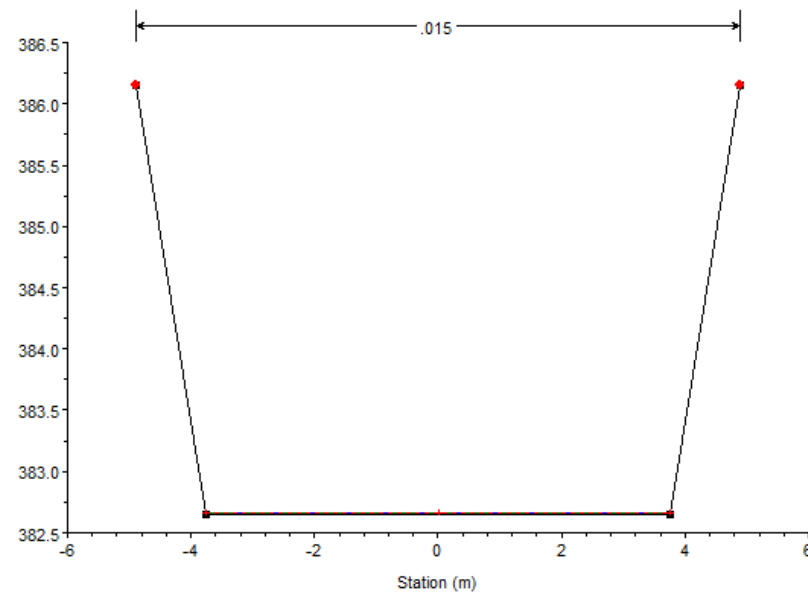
Sección tipo 3, tramo 1.2 del canal de Monegros.
